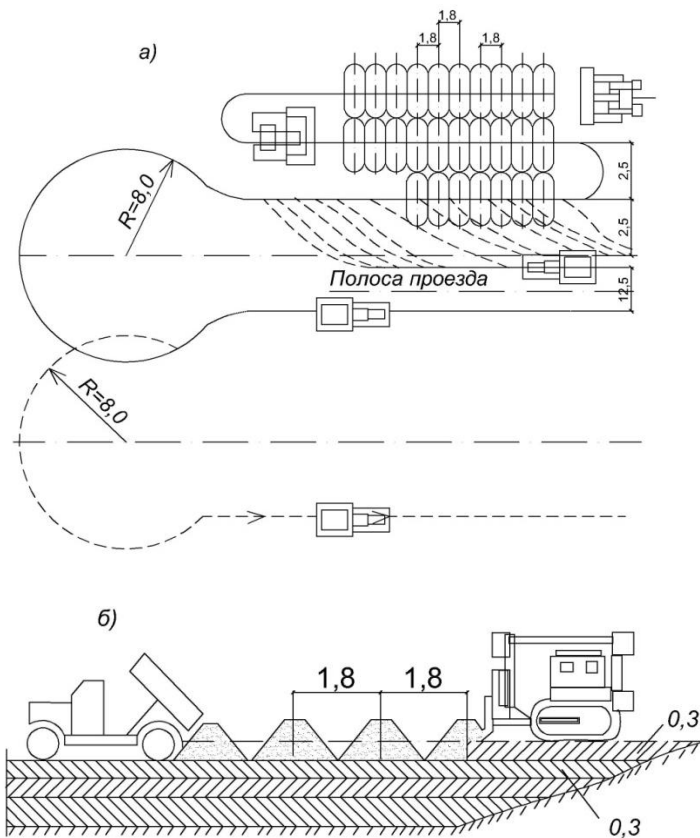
Схема образования насыпи при подвозе недостающего грунта самосвалами: а - план; б - разрез
